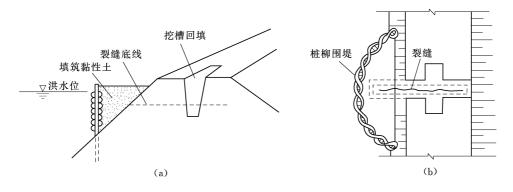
横墙隔断处理裂缝示意图 (a) 剖面图; (b) 平面图
